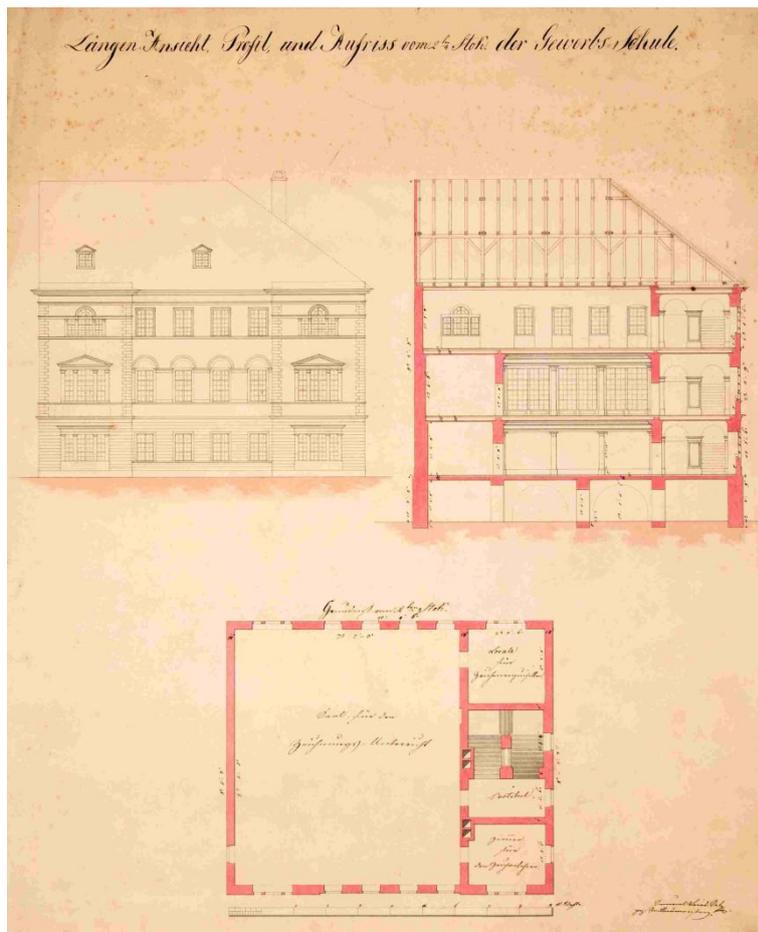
Ansicht, Schnitt und Grundriss des 2. Obergeschosses der Gewerbeschule auf dem Huetplatz in Hermannstadt – nicht ausgeführt
